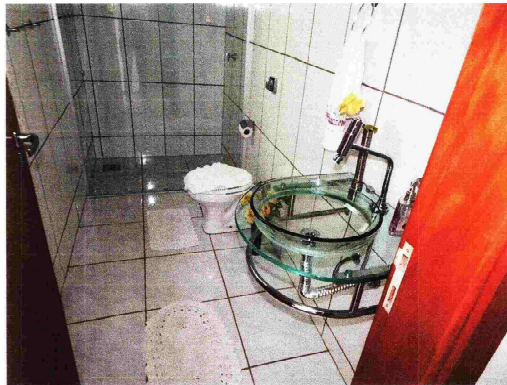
VISTA INTERNA BANHEIRO SOCIAL
